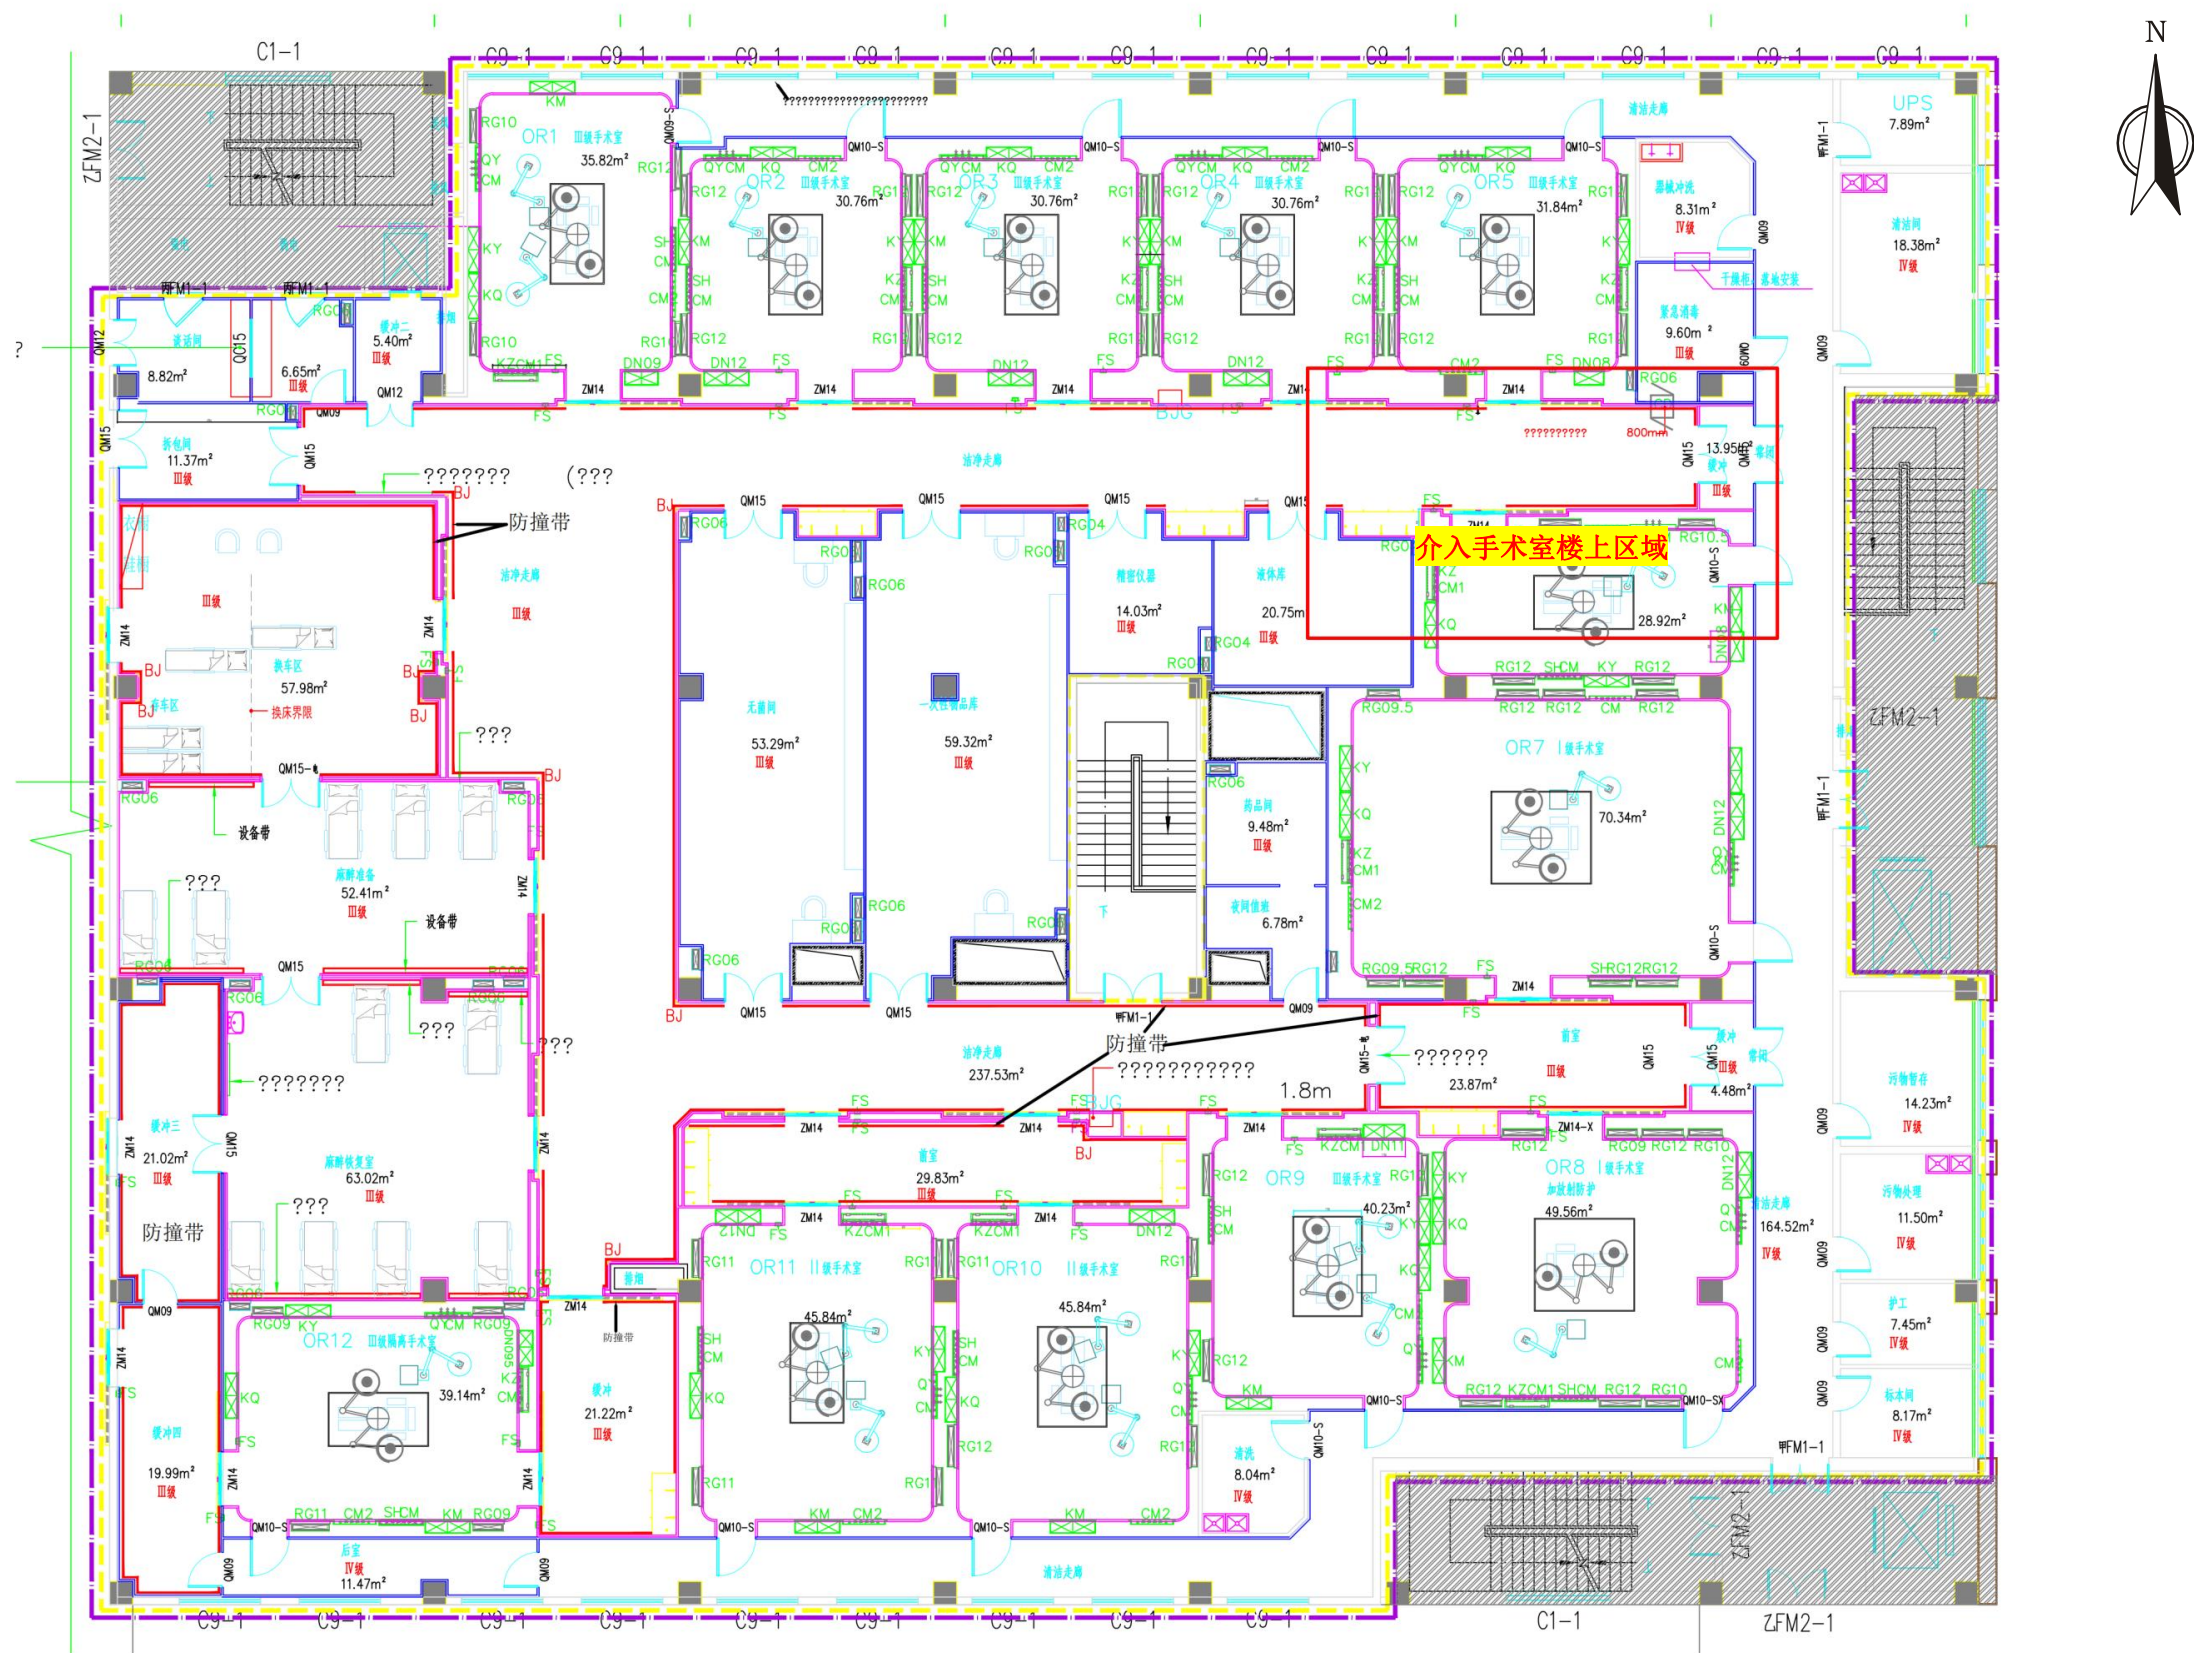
聊城市第二人民医院华美院区医技楼 5 层平面位置示意图 (介入手术室楼上)
